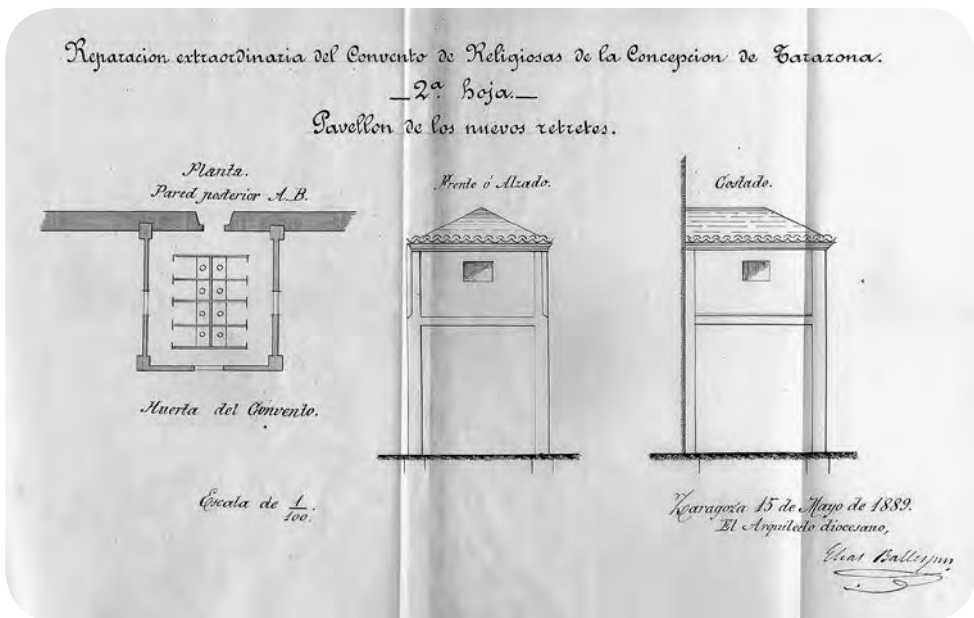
Planta y alzados. Proyecto de reparación de los excusados del convento de la Concepción de Nuestra Señora, arquitecto Elías Ballester, 1889. Plano A.D.T.
